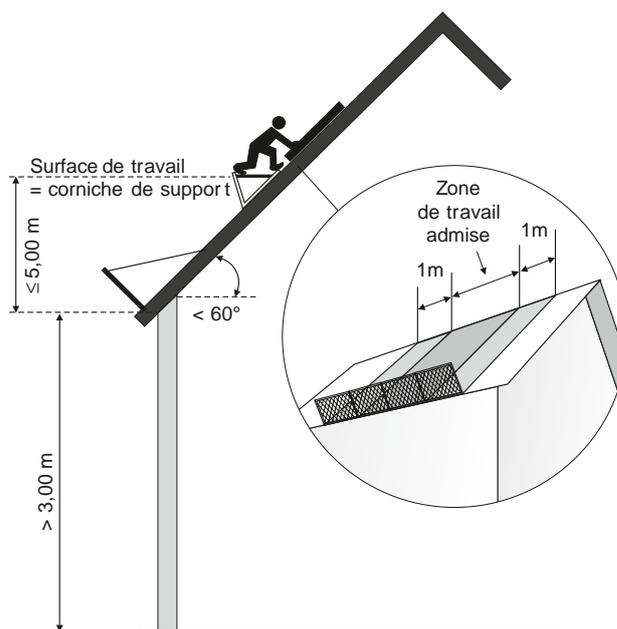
Grilles de protection pour travaux en toitures inclinées
